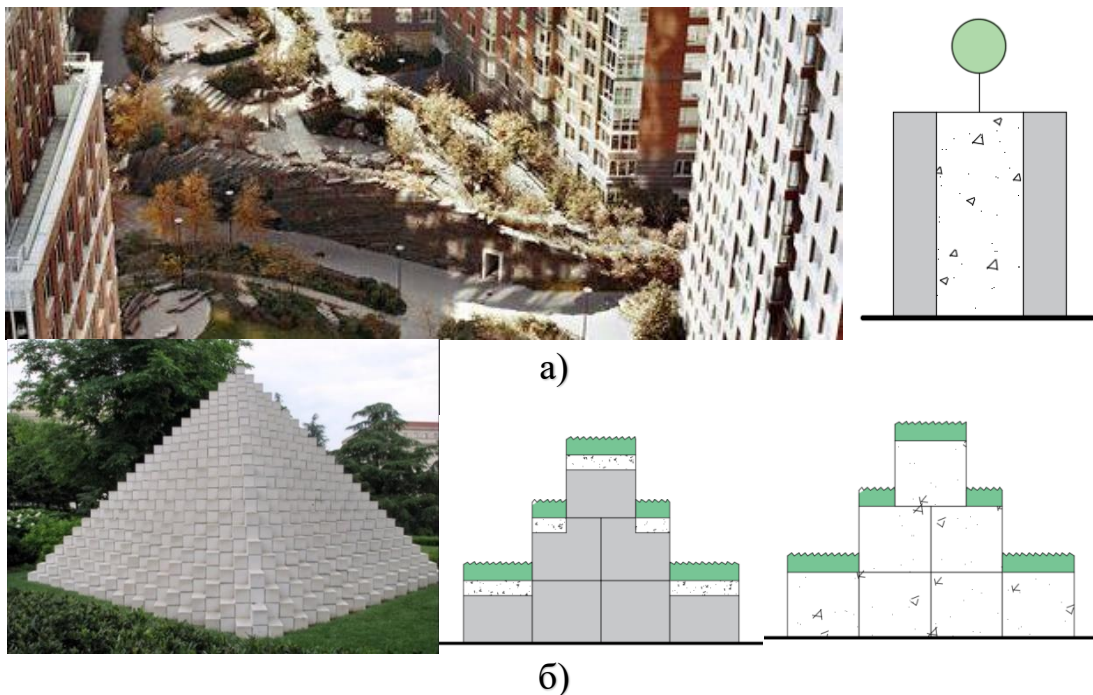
Конструктивные системы подпорных стен для создания геопластики: а - конструкция с двумя вертикальными гранями; б – конструкция со ступенчатыми гранями.
